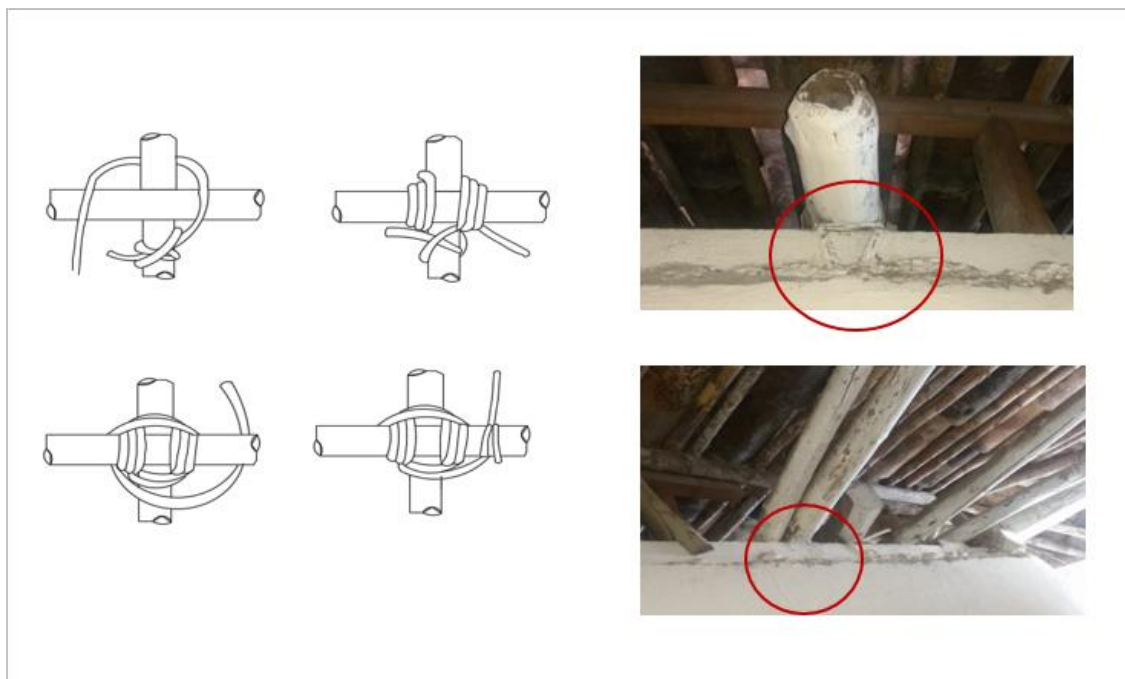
Detalle de amarres en estructura de cubierta en viviendas de bahareque. Elaboración propia
